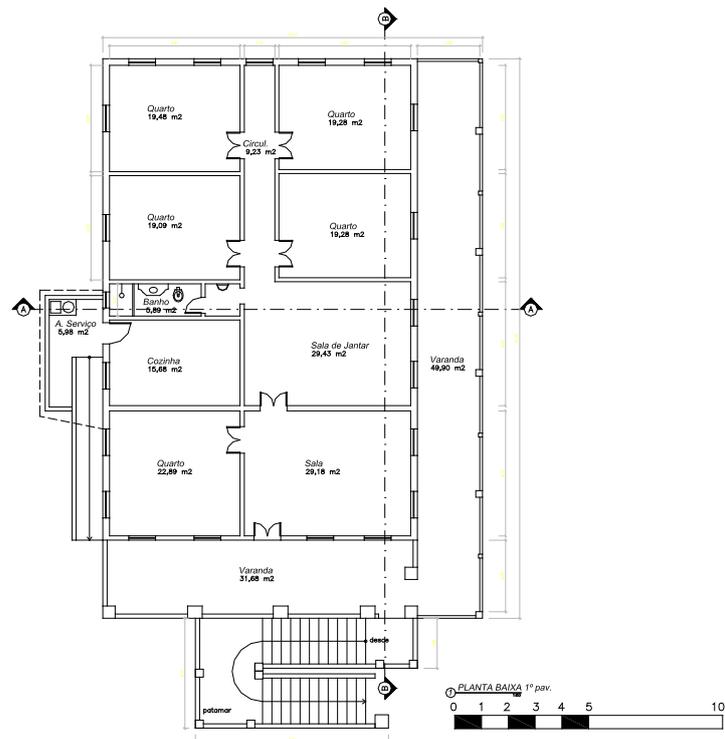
Planta segundo pavimento - Casa do Ozorinho
